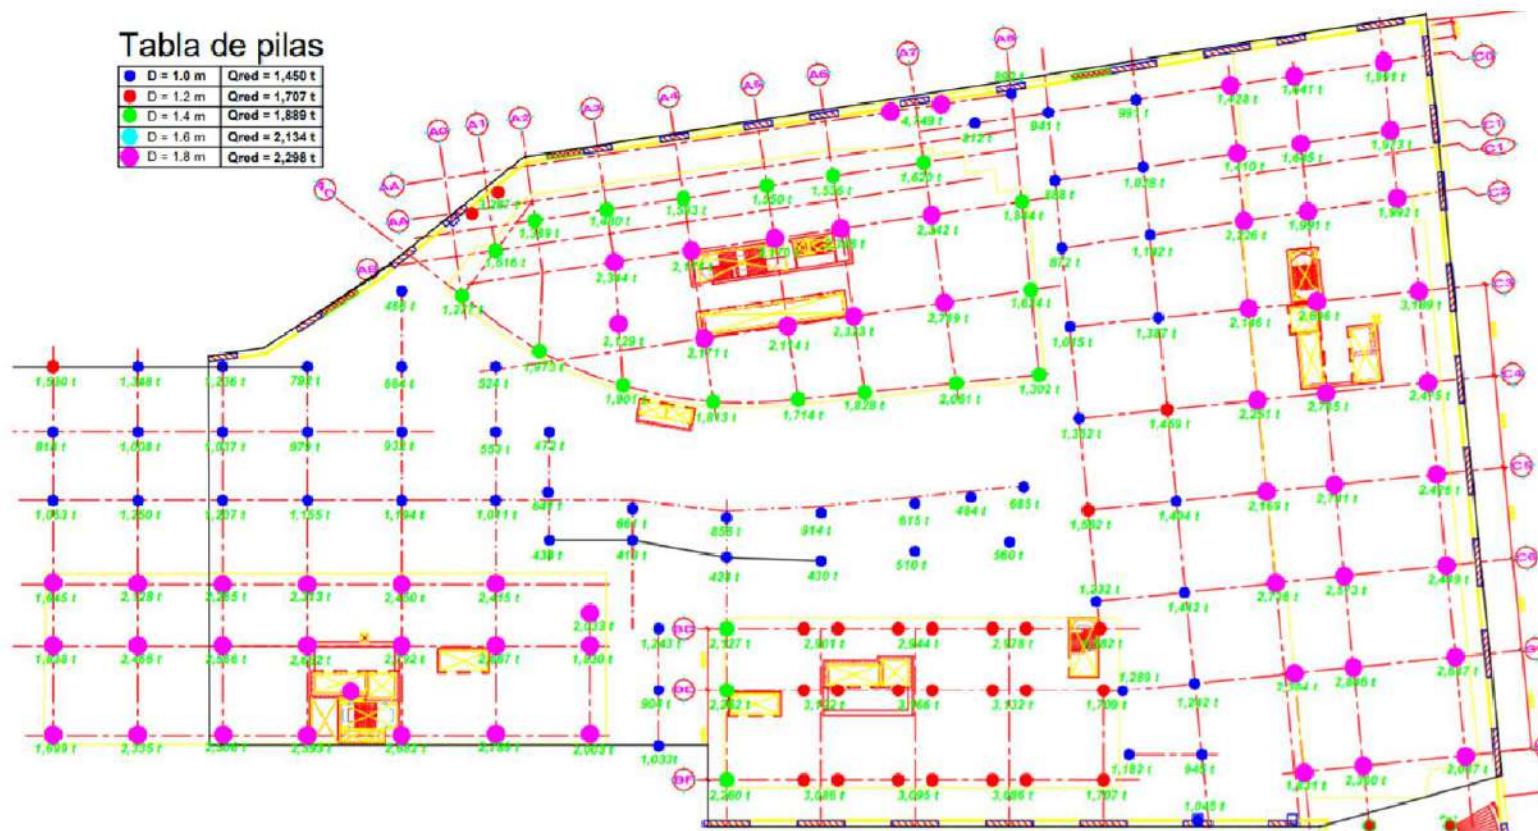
Distribución en planta de las pilas propuesta para la alternativa de cimentación mediante pilas desplantadas a 58m de profundidad en la unidad DAL.
